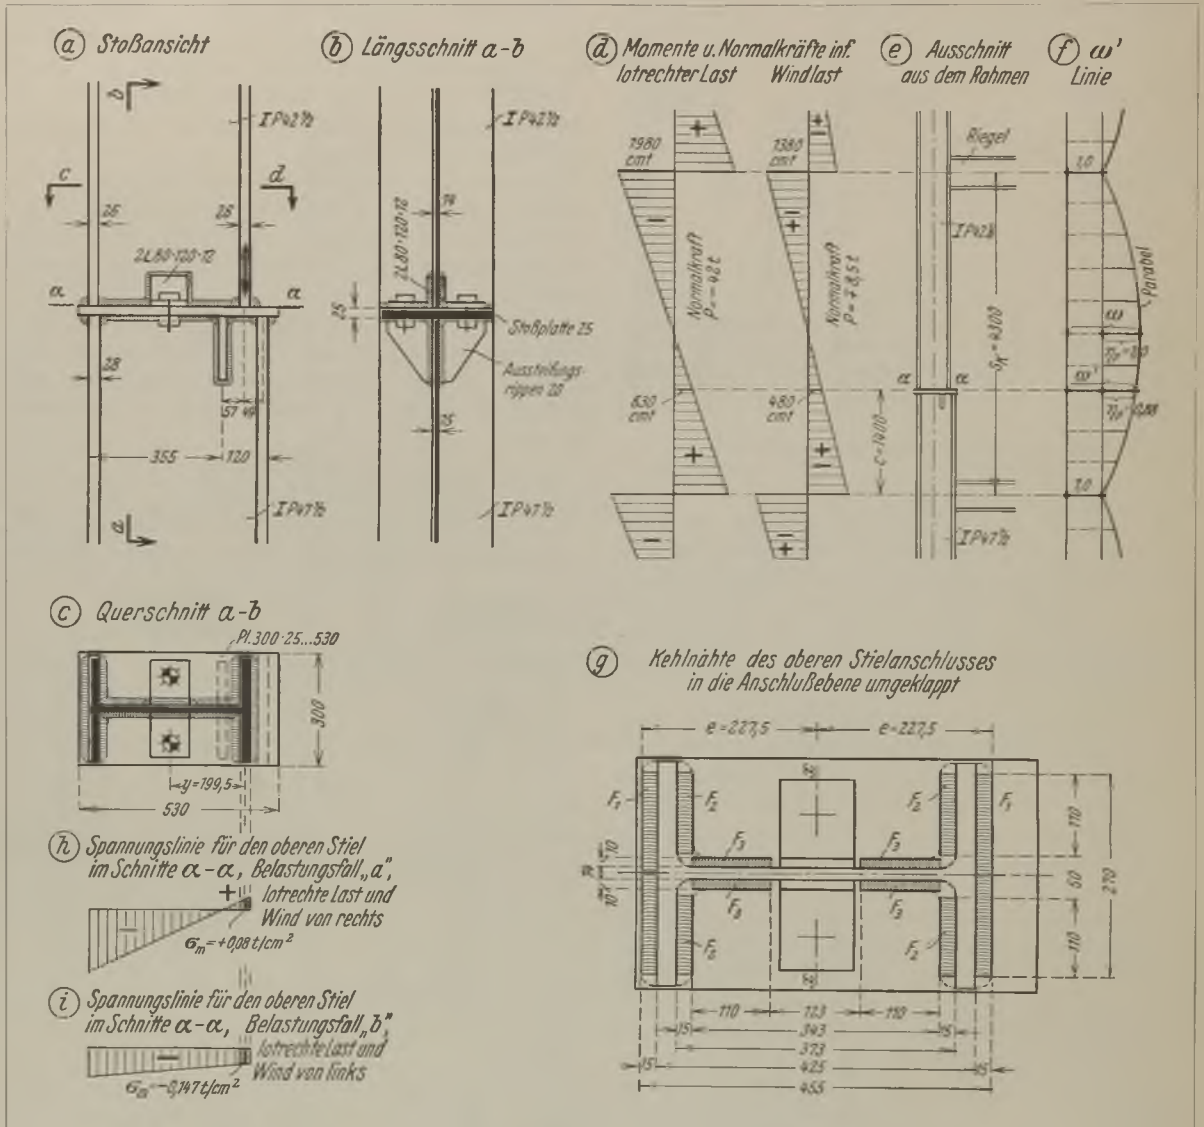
Stoßausführung der Außenstütze eines Stockwerkrahmens für Baustellenschweißung.
